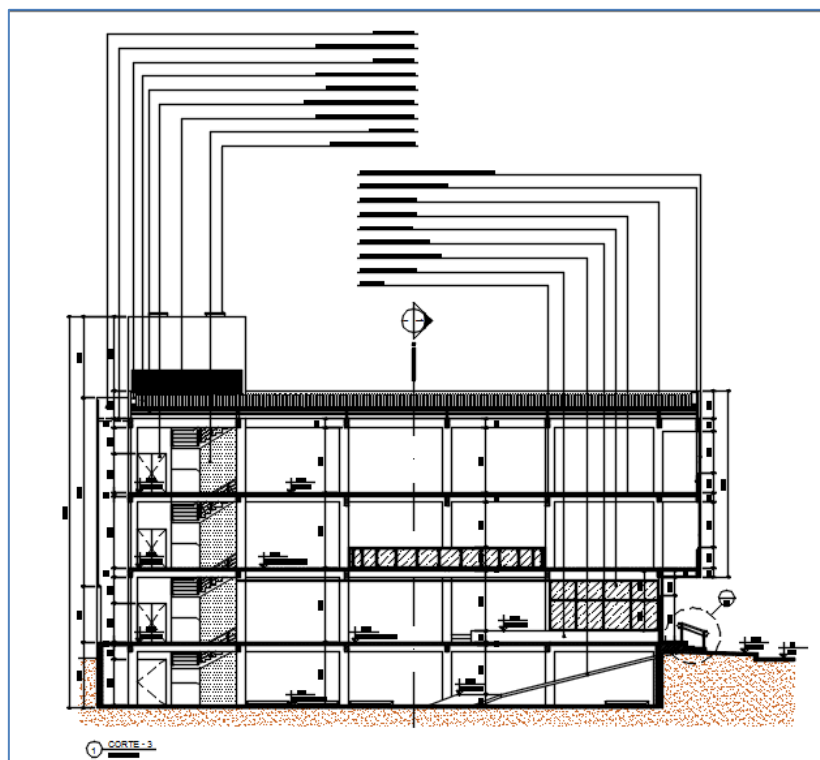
Planta baixa: corte-3 (autor do projeto arquitetônico)
